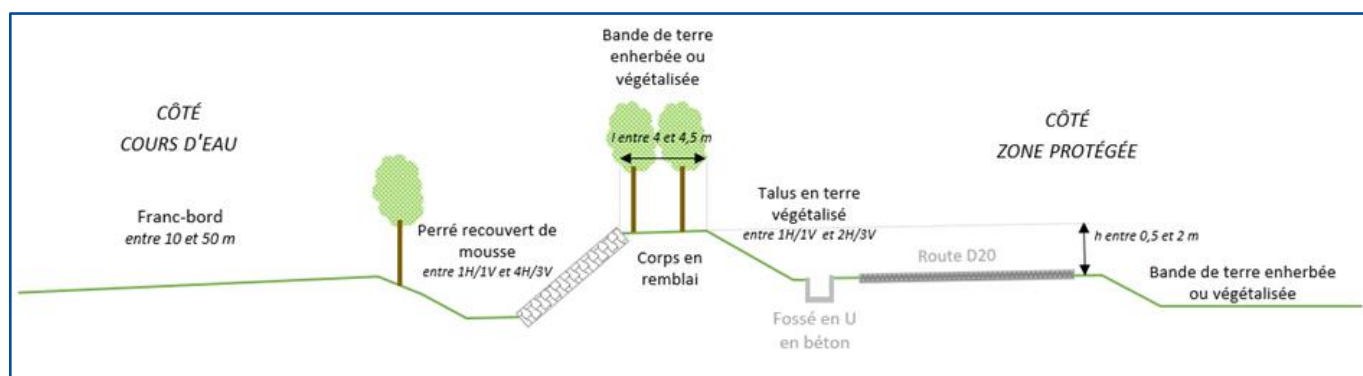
Coupe type du système d'endiguement de Lamothe – Tronçon 1 / Section a (T1a)
